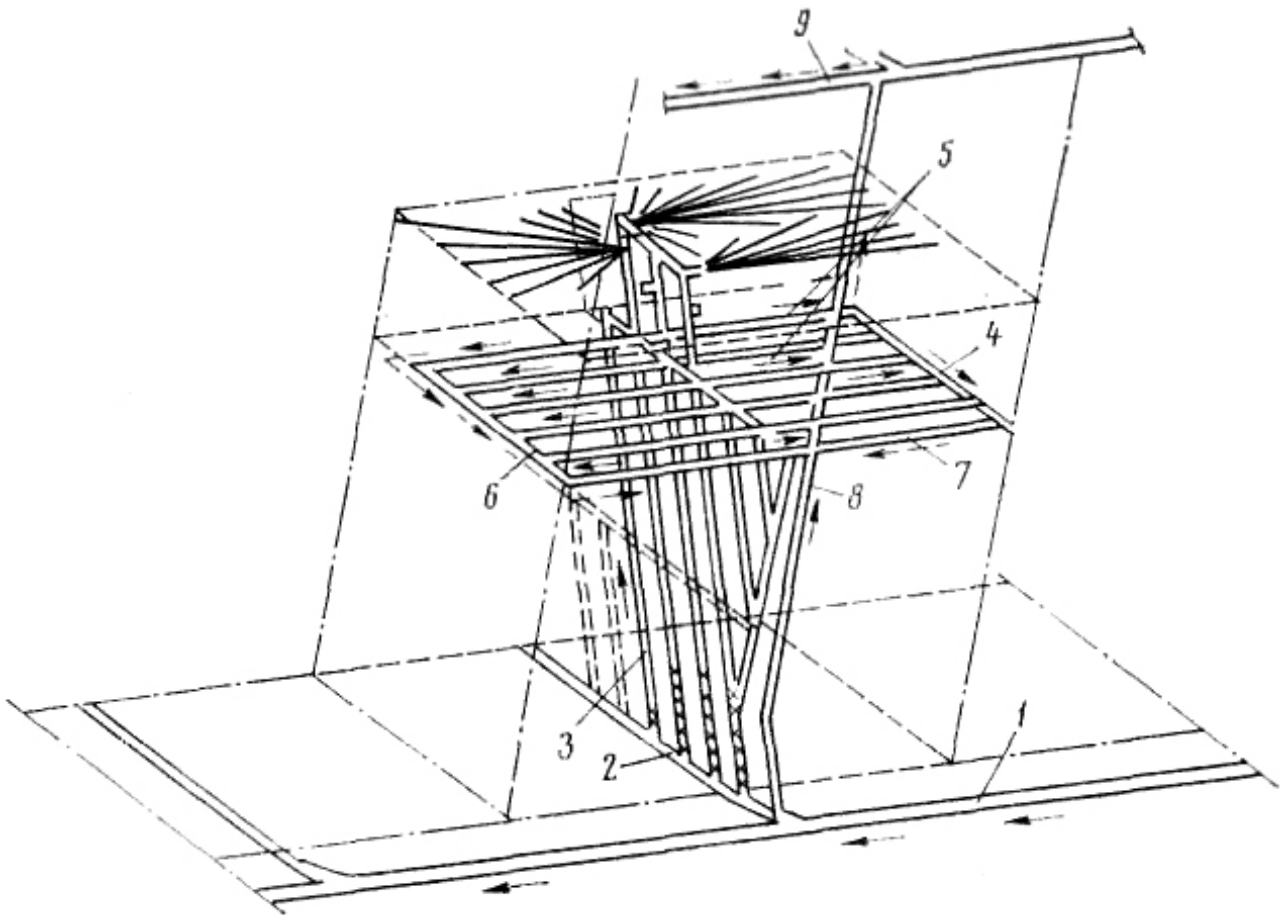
Схема вентиляции блока при подэтажном обрушении с отбойкой руды горизонтальными скважинами:
